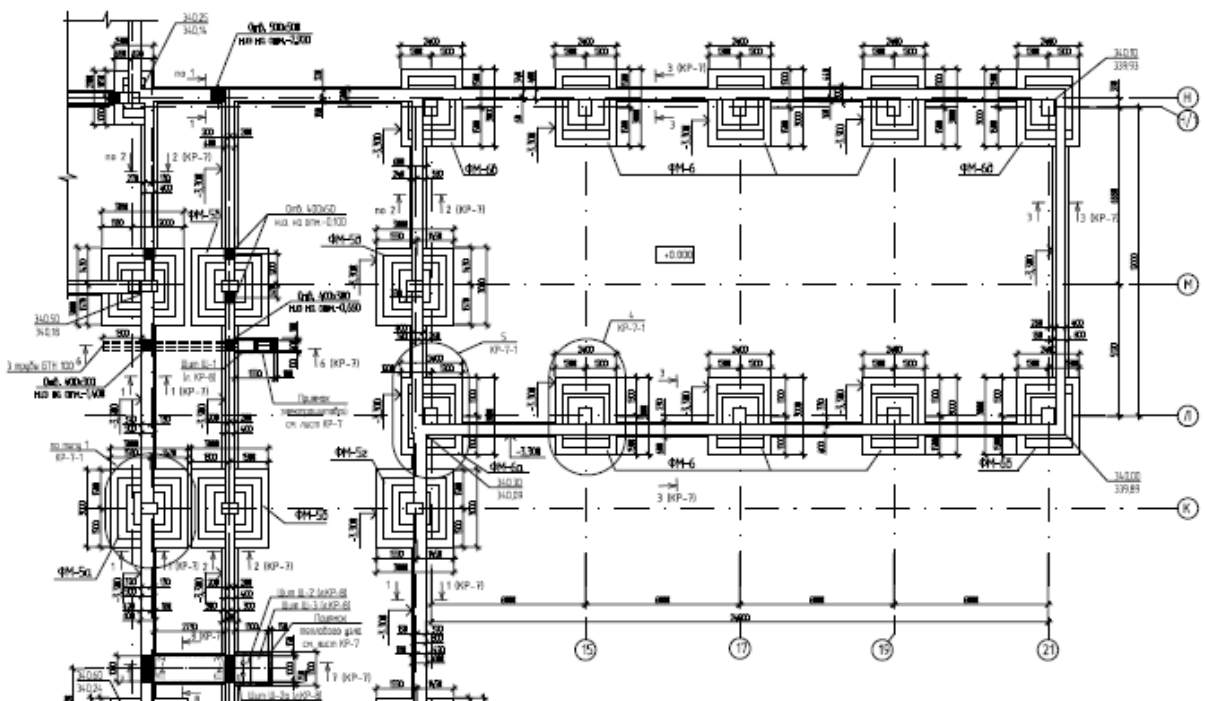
Схема расположения элементов фундамента в осях 9-21, И-Н
